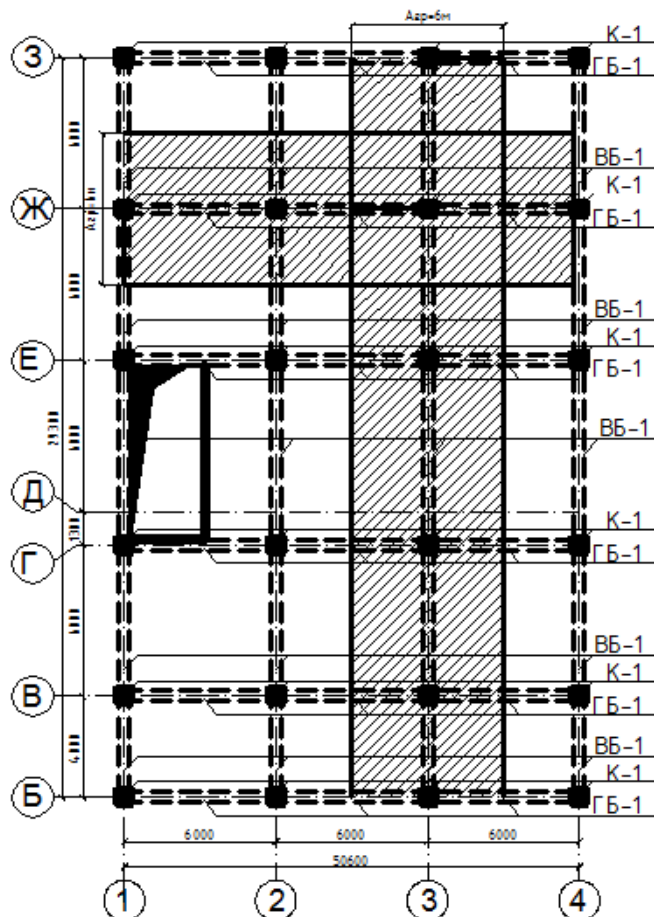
Схема расположения элементов монолитного междуэтажного перекрытия
